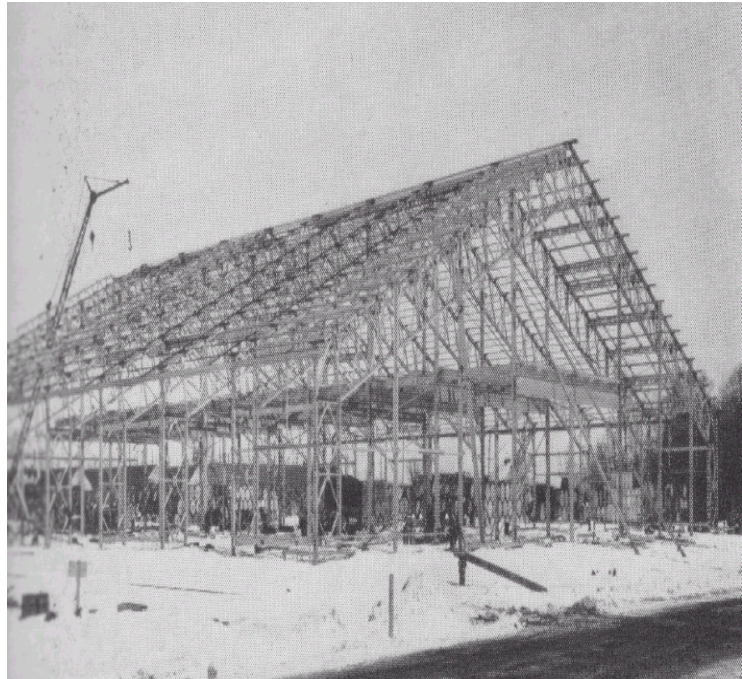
Tijeras de techo hechas con paneles de puente Bailey en Sudáfrica
